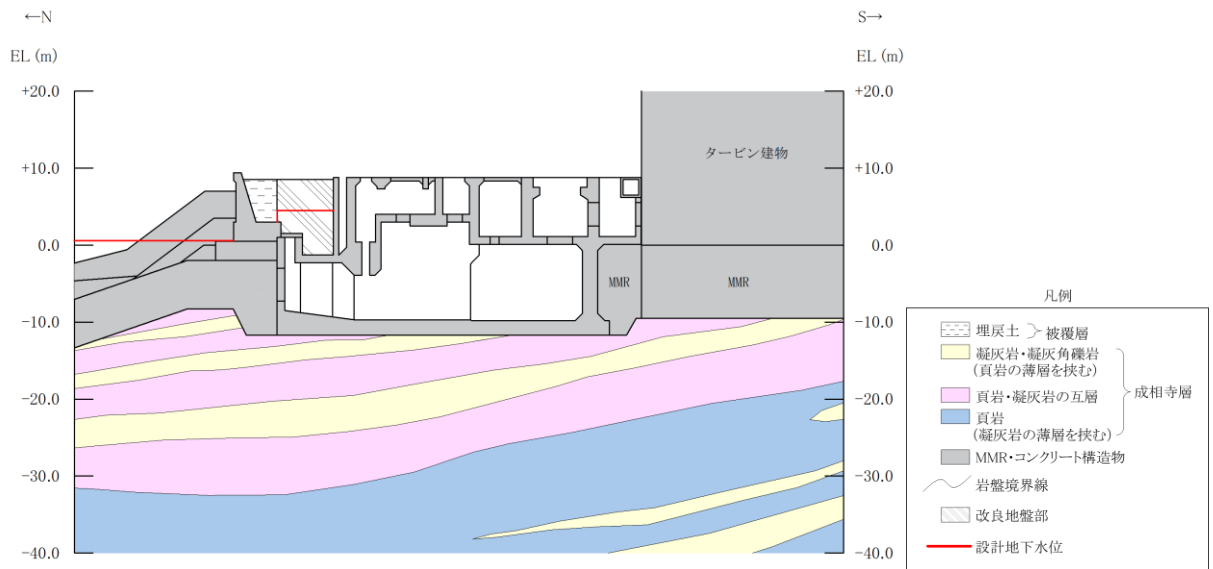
取水槽 地震時荷重算出断面図 (D-D 断面)
